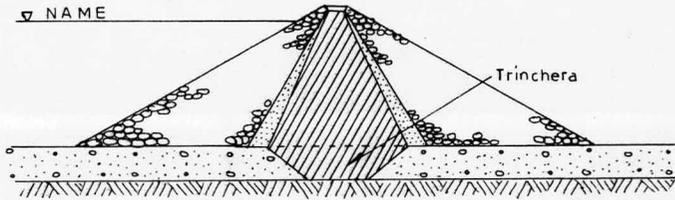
Sección de cortina de tierra y enrocamiento con trinchera ( $H_c < 20 \text{ m}$ ).
